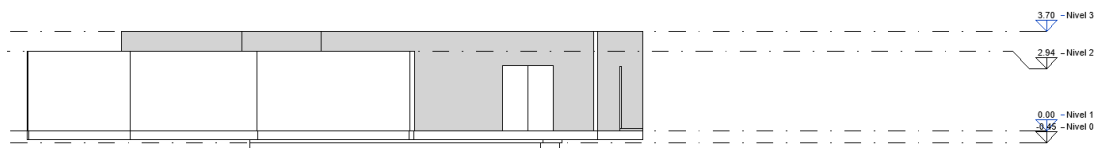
Alzado Sur modelo levantamiento con SLAM. Fuente: elaboración propia.
